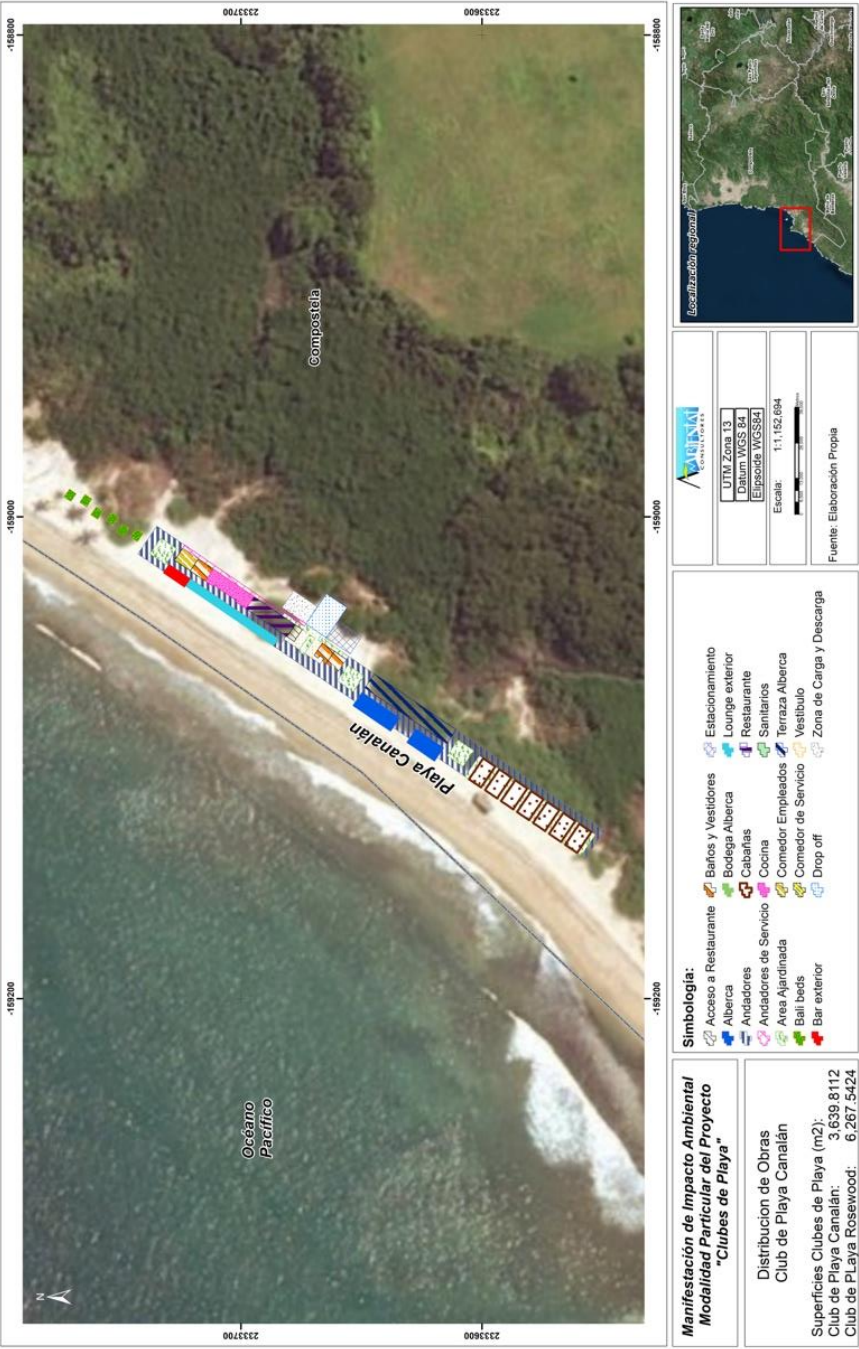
Desplante de obras del Proyecto Club de Playa Canalán en playa Canalán.
